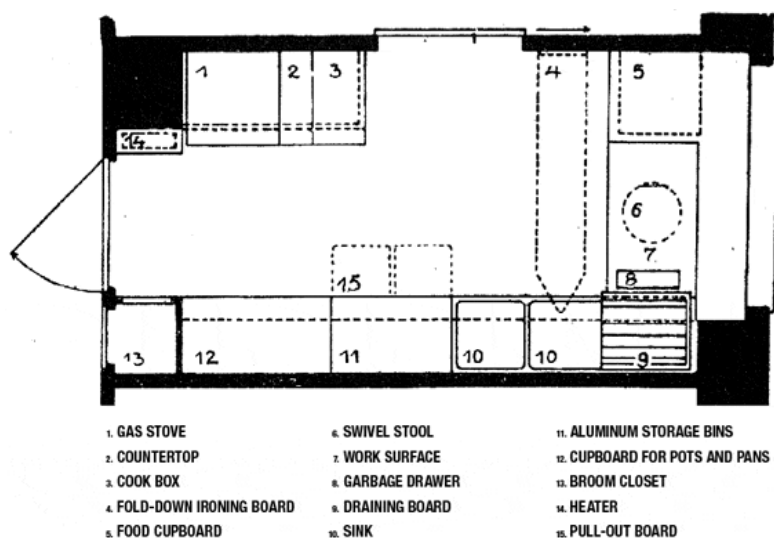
Planta da Cozinha Frankfurt, por Margarete.
